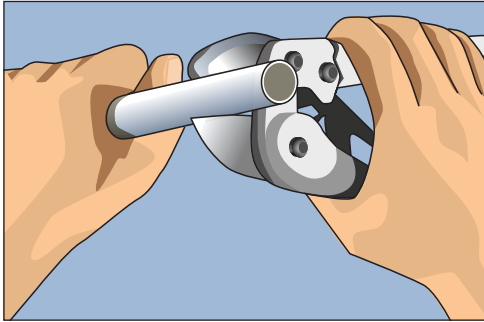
Разрезаем трубу с помощью специальных ножниц (ножовки по металлу или трубореза для пластиковых труб)
